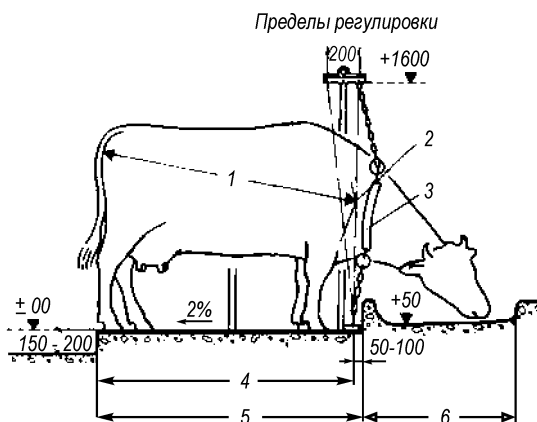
Боковой вид и размеры короткого стойла (корова стоит):
